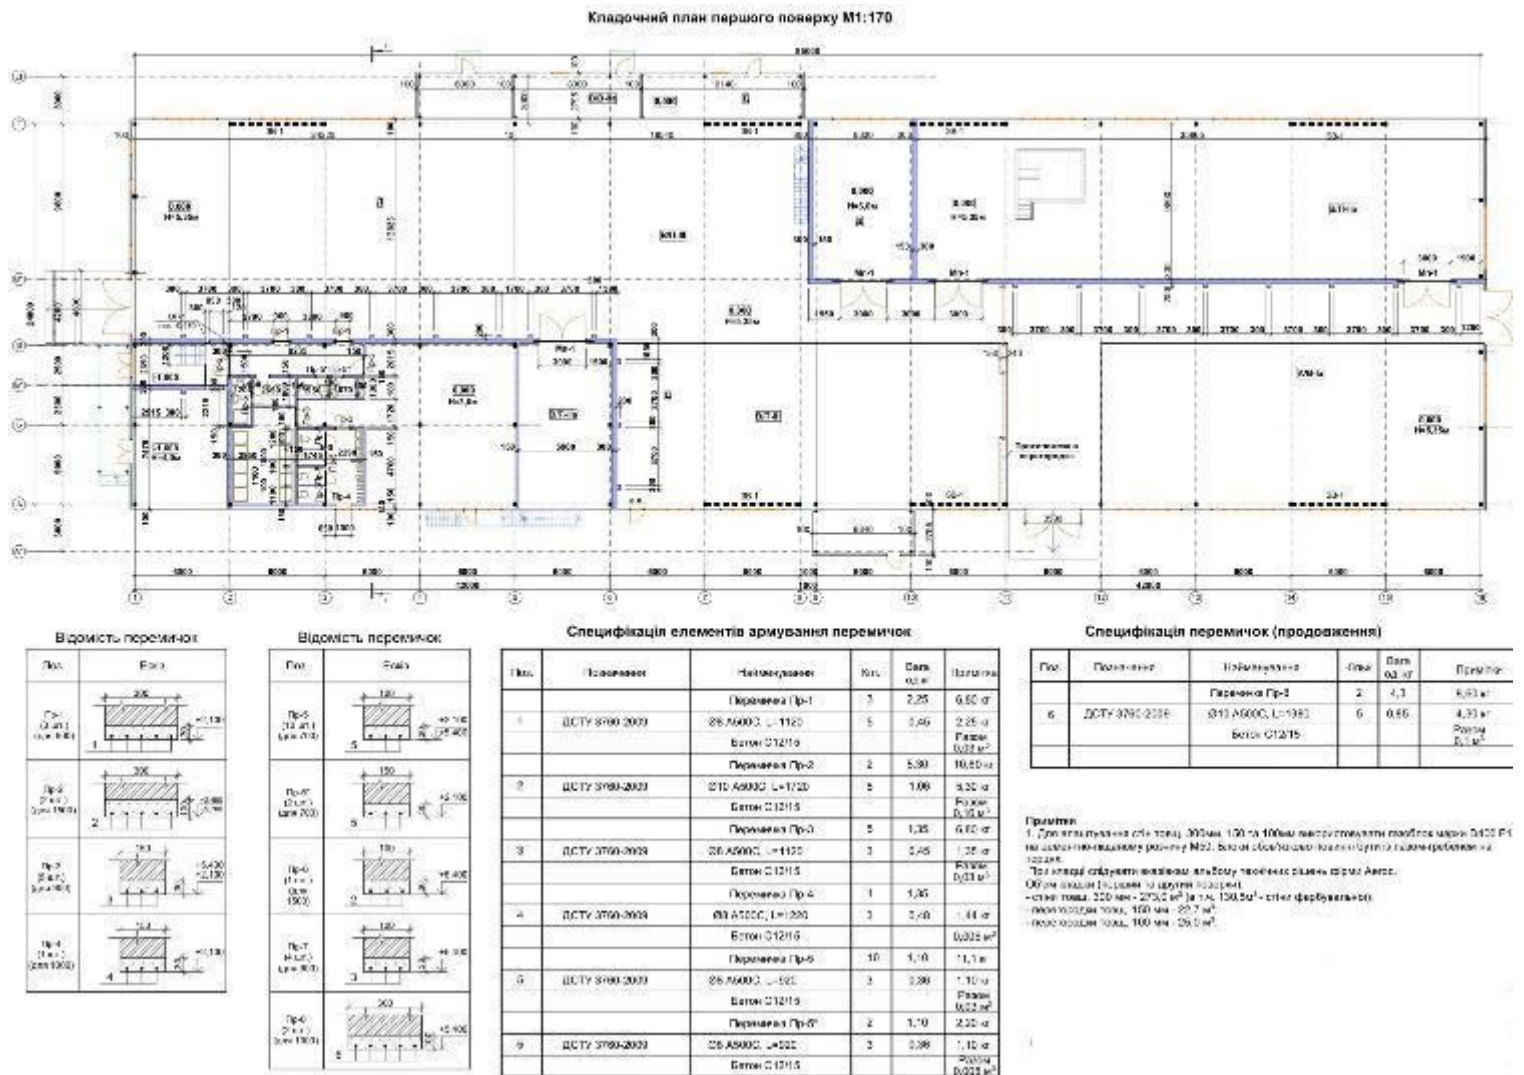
Кладочний план першого поверху (масштаб 1:70)
